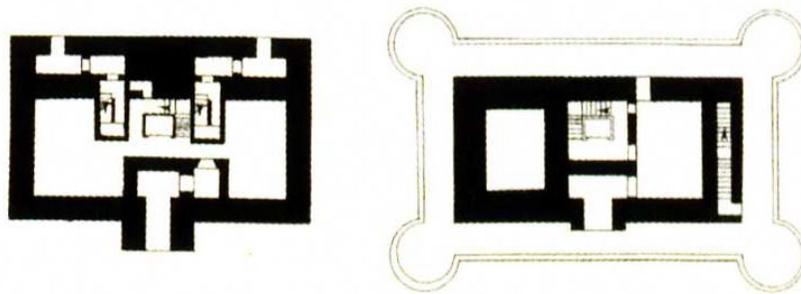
Pianta piano terra, pianta ultimo piano della torre LV.
